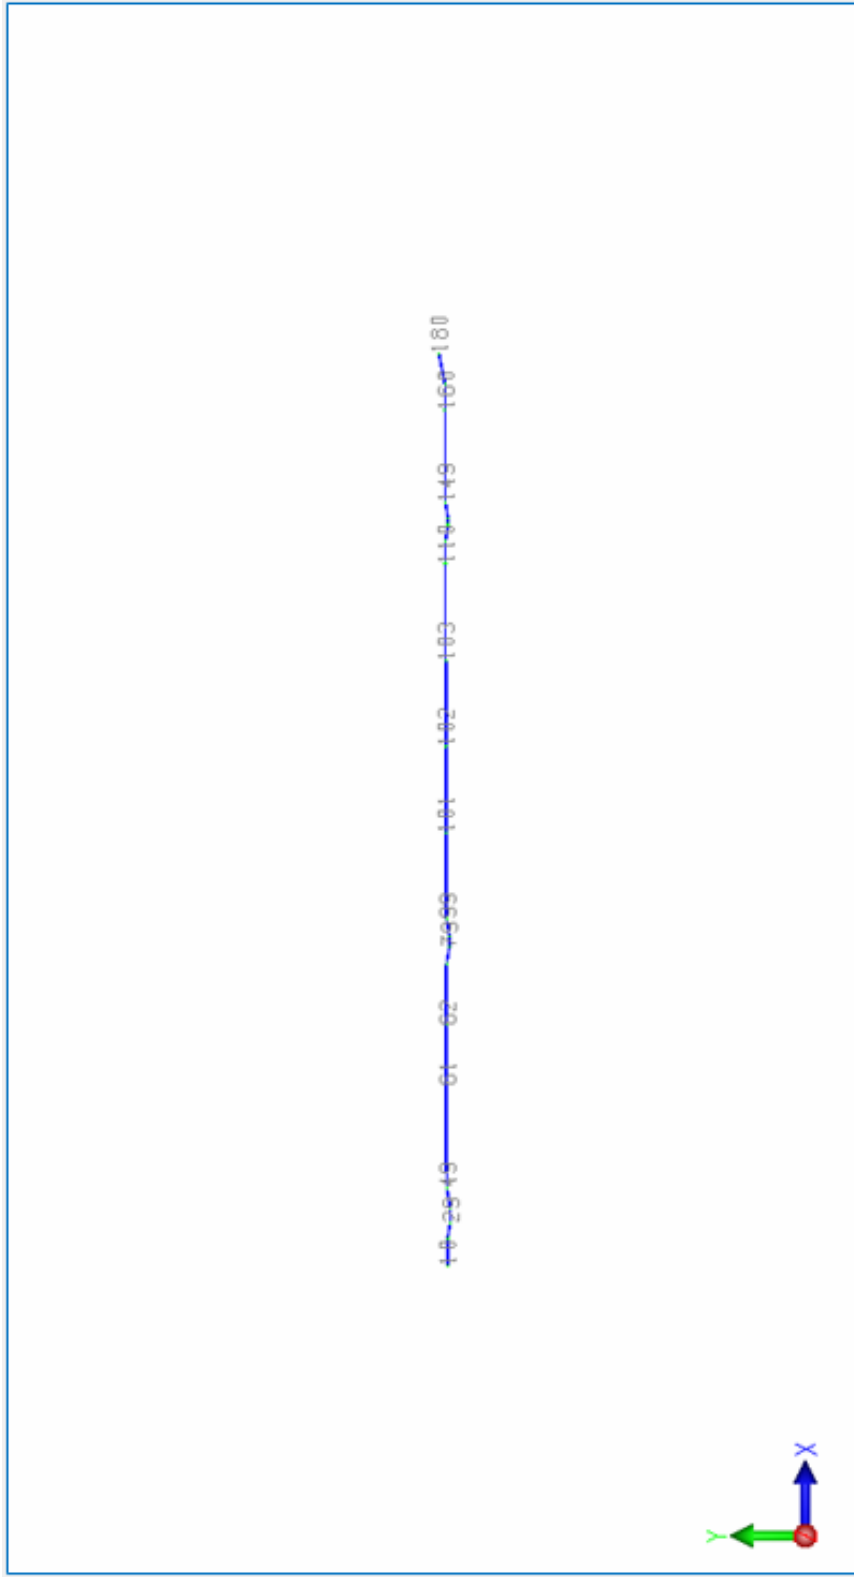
Vista frontal del modelo tridimensional para el cruce de fallas de El Pilar
